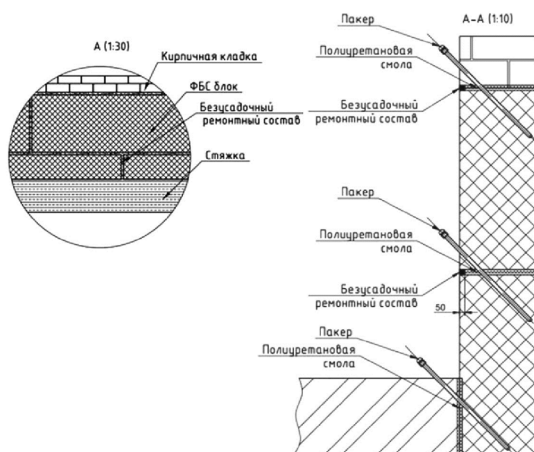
Схема гидроизоляции подвала из фундаментных блоков методом инъектирования полиуретановыми смолами
